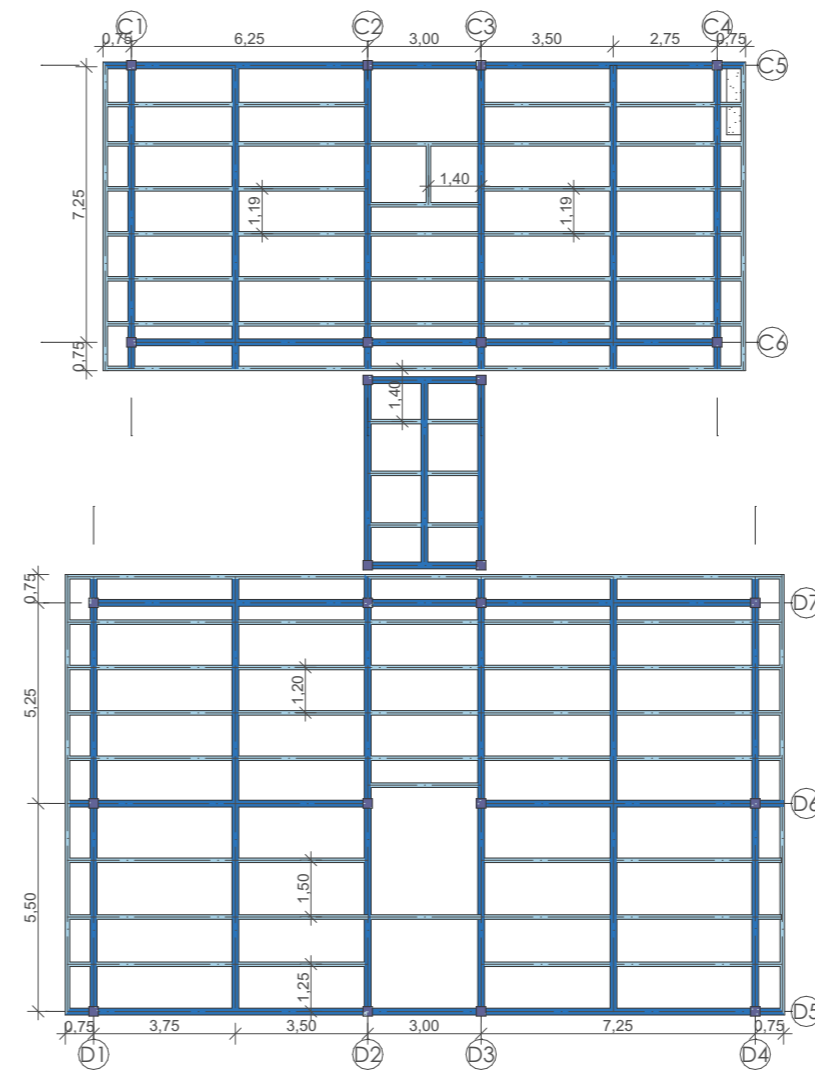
Planta de estructura del Bloque C y D Elaboración propia (2026). Escala 1:200
